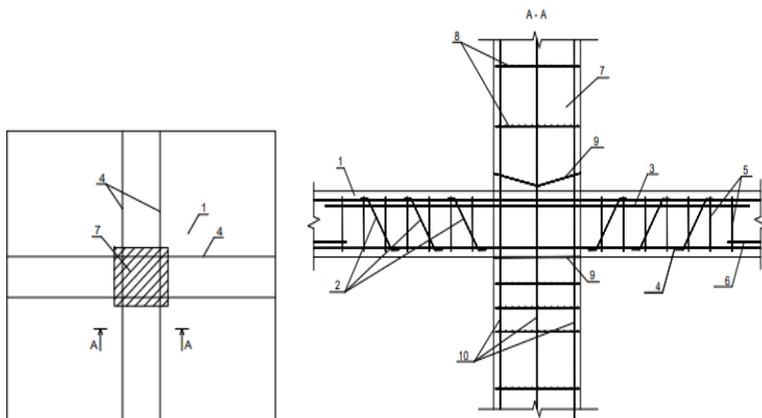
Узел примыкания монолитной плиты перекрытия к колонне:
